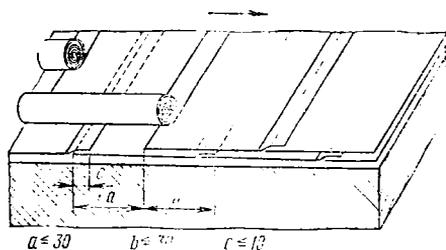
Раскатываемые рулонные материалы гидроизоляции.
